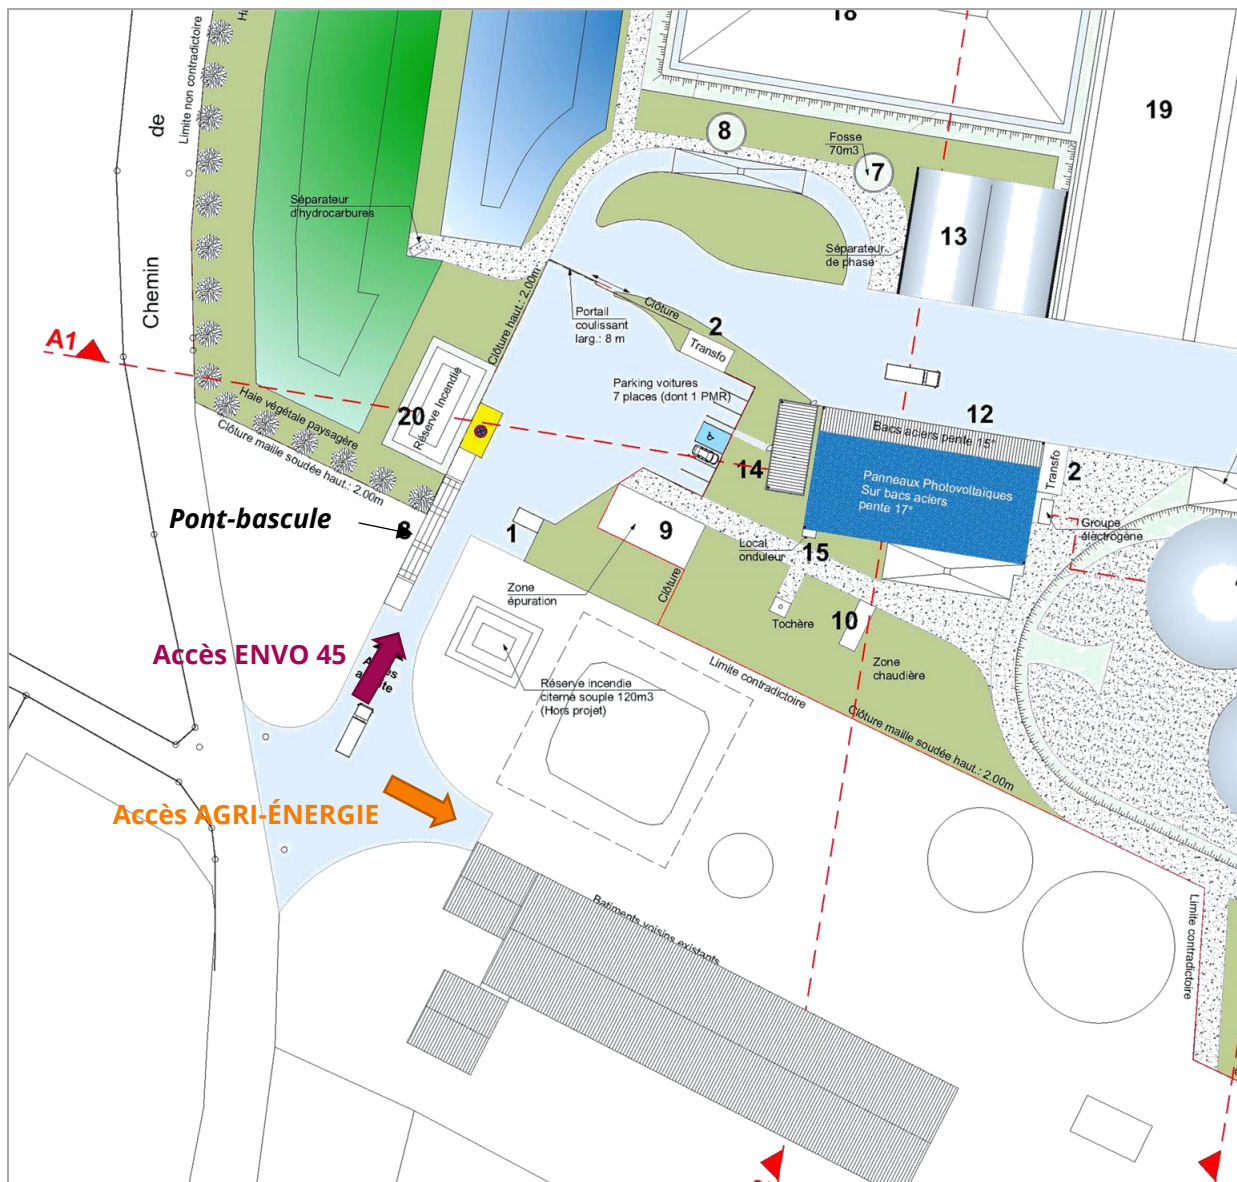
Extrait du plan de masse avec zoom sur les accès depuis la voie communale
